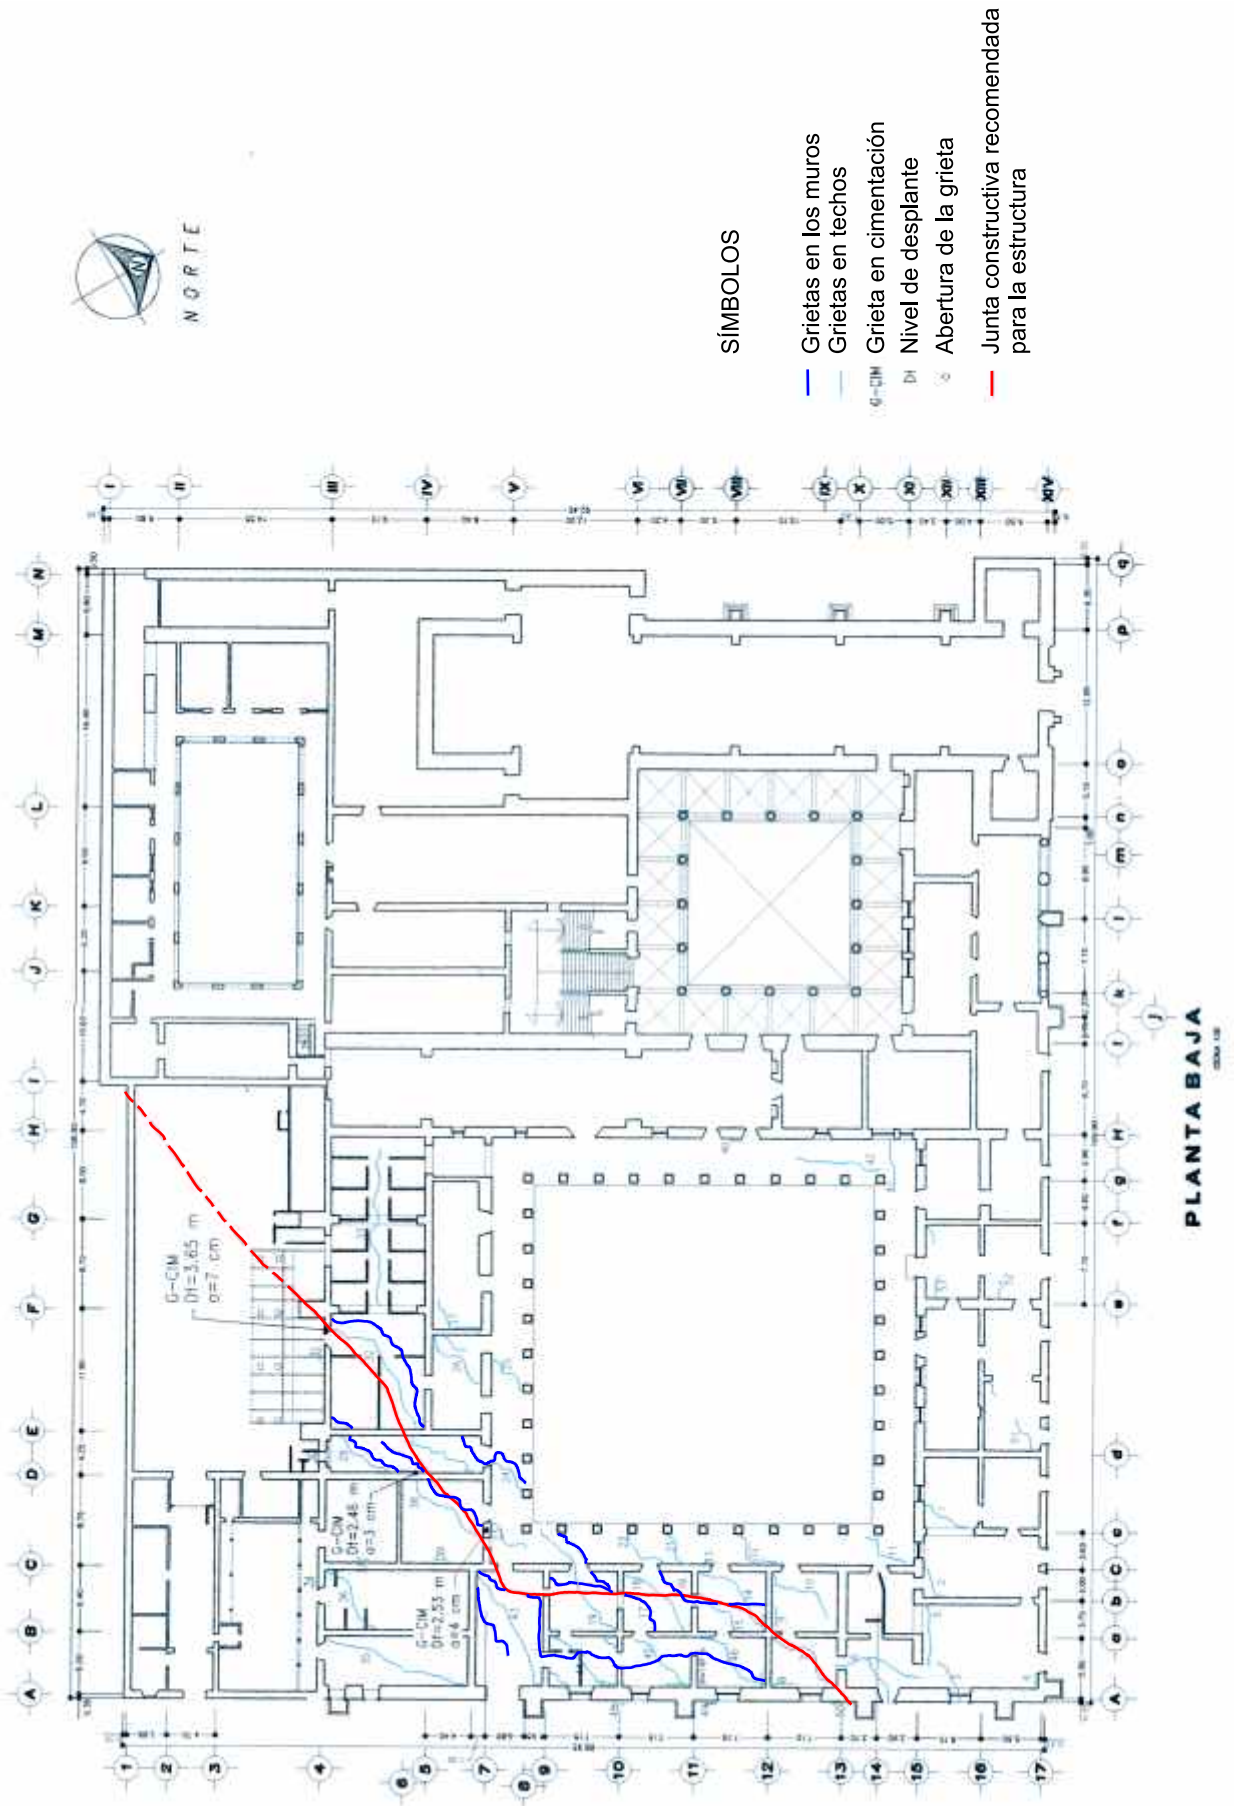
Levantamiento de grietas en planta baja
